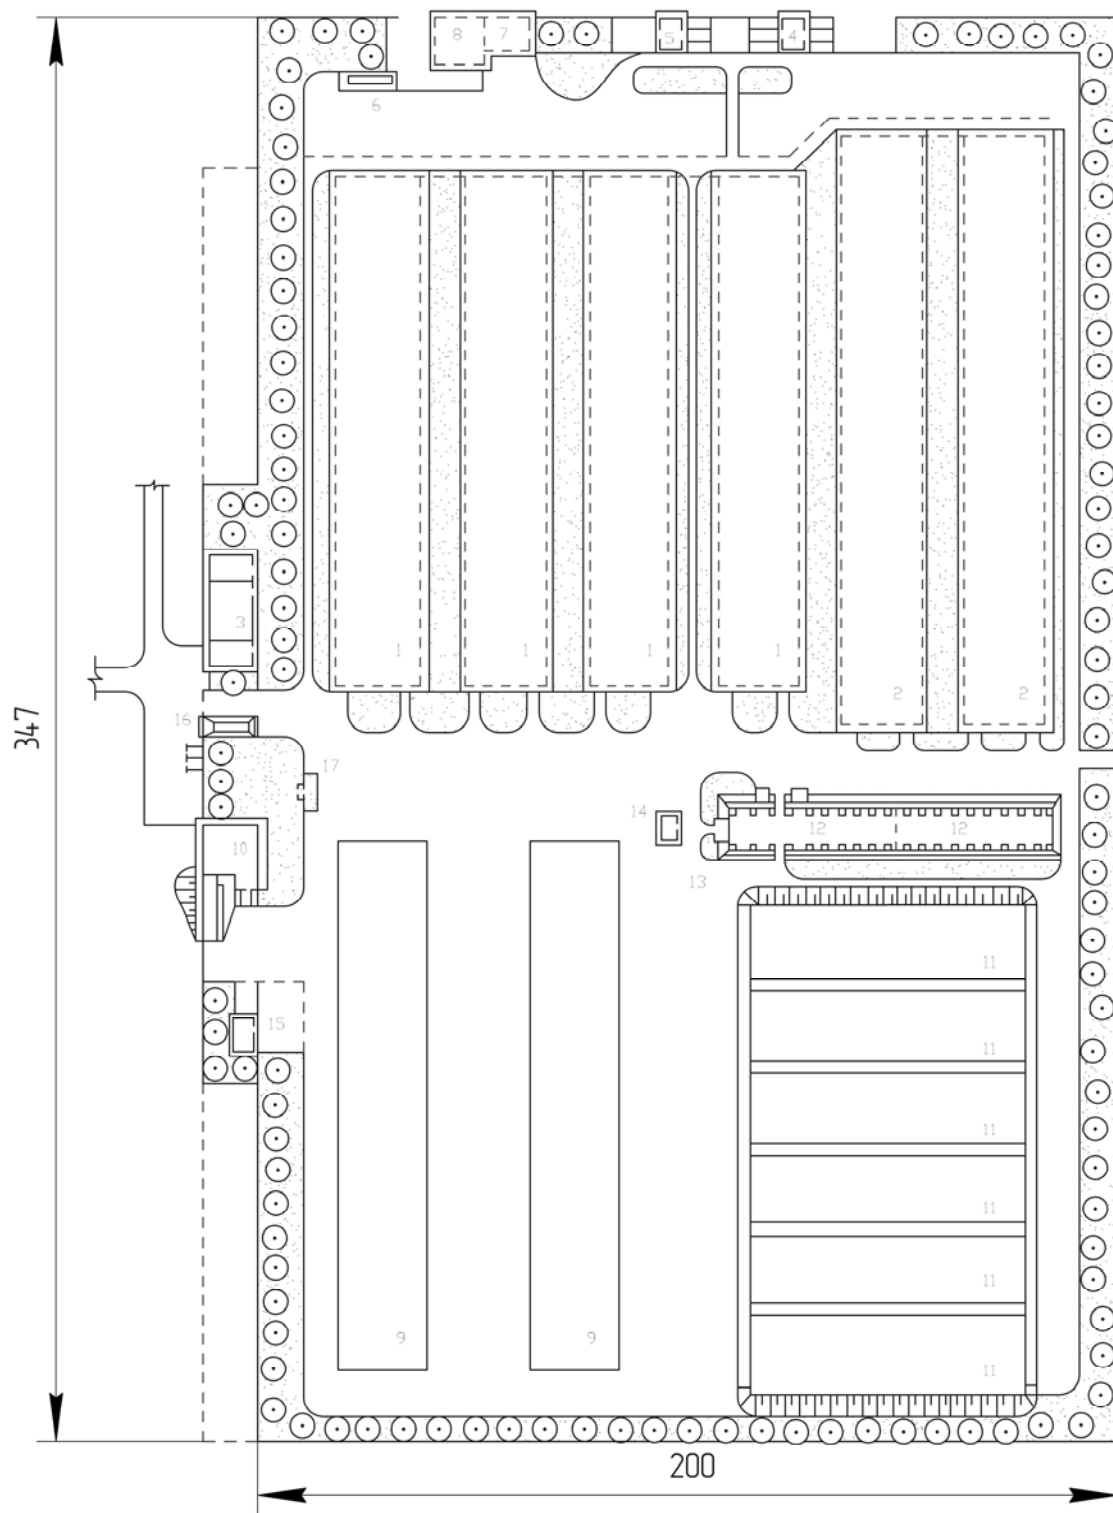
Генеральний план ферми дорощування і відгодівлі великої рогатої худоби на 5 тис. голів за рік (ТП 801-01-29-83, УкрНДІагропроект): 1 – будівлі для дорощування 860 голів молодняку; 2 – будівлі для відгодівлі 840 голів молодняку; 3 – ветсанпропускник; 4 – будівля для відправки худоби; 5 – будівля для приймання худоби; 6 – дезбар’єр; 7 – ветамбулаторія; 8 – забійно-санітарний пункт; 9 – жомосховище на 10 тис. т.; 10 – склад комбікормів на 360 т; 11 – силососховища по 3000т; 12 – навіси для сіна по 200т; 13 – м’ясосховище; 14 – трансформаторна підстанція; 15 – пункт технічного обслуговування; 16 – дезбар’єр; 17 – автовагова.
